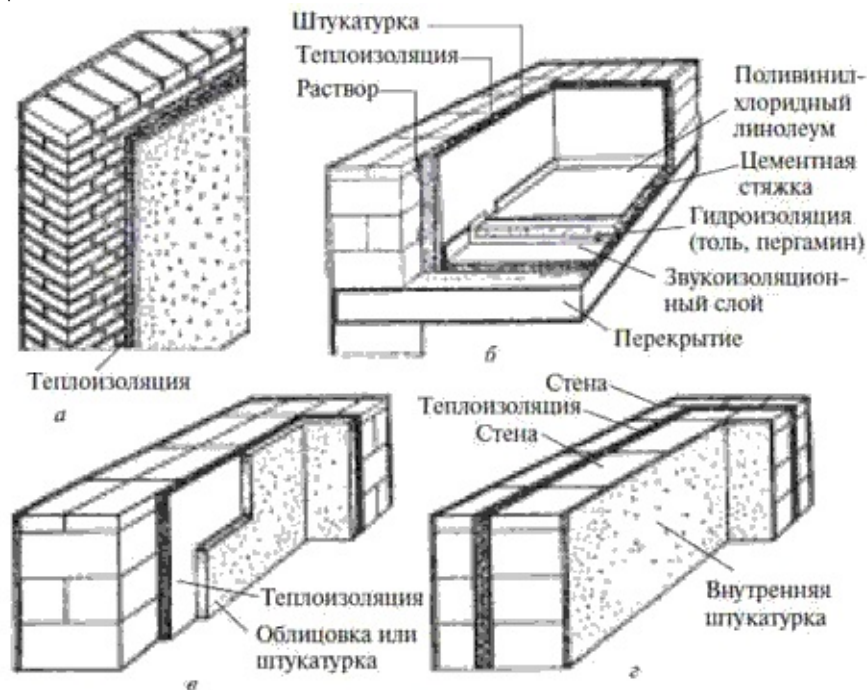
Устройство теплоизоляции на внутренней стороне стены и внутри каменной кладки:
